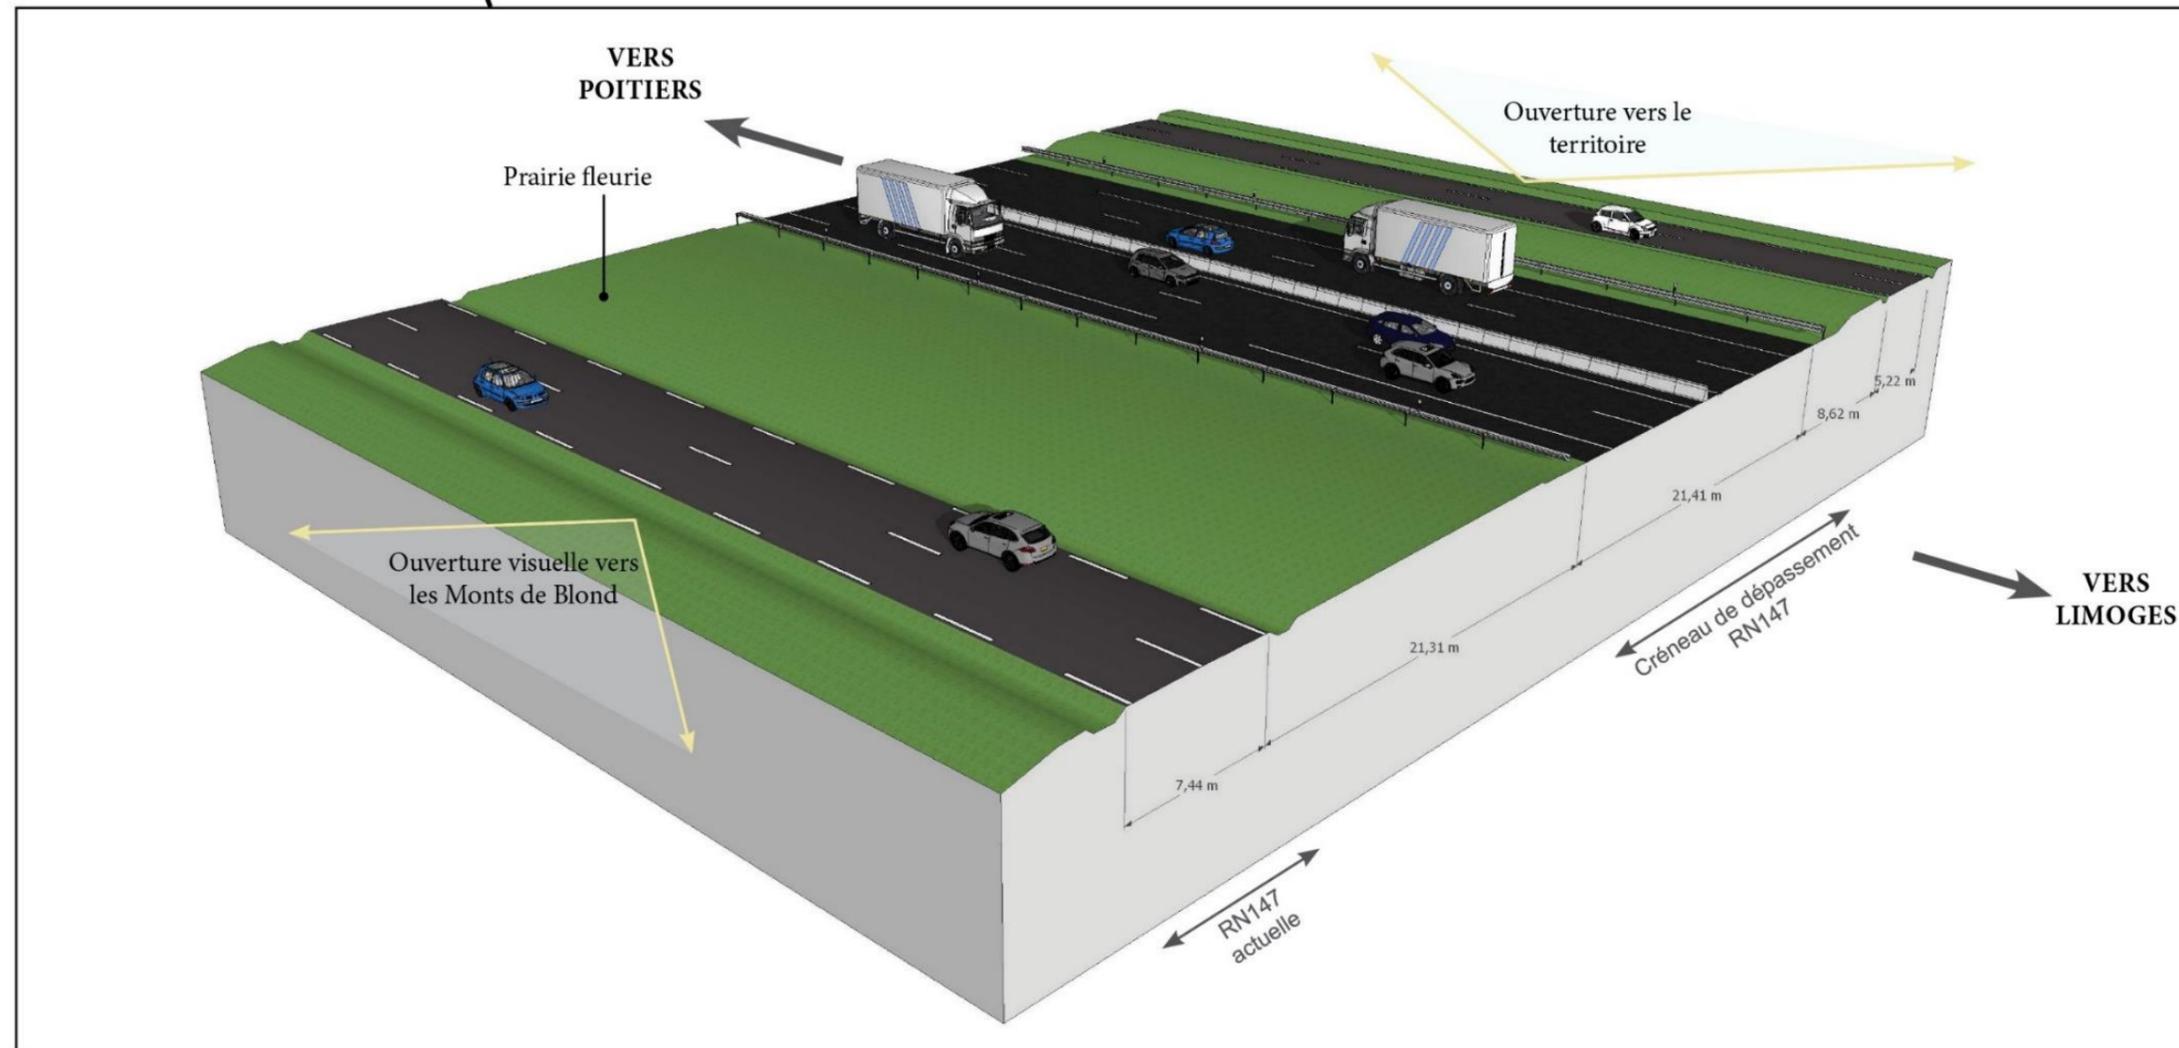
Vue 3D au niveau de la section Berneuil (Sud)
